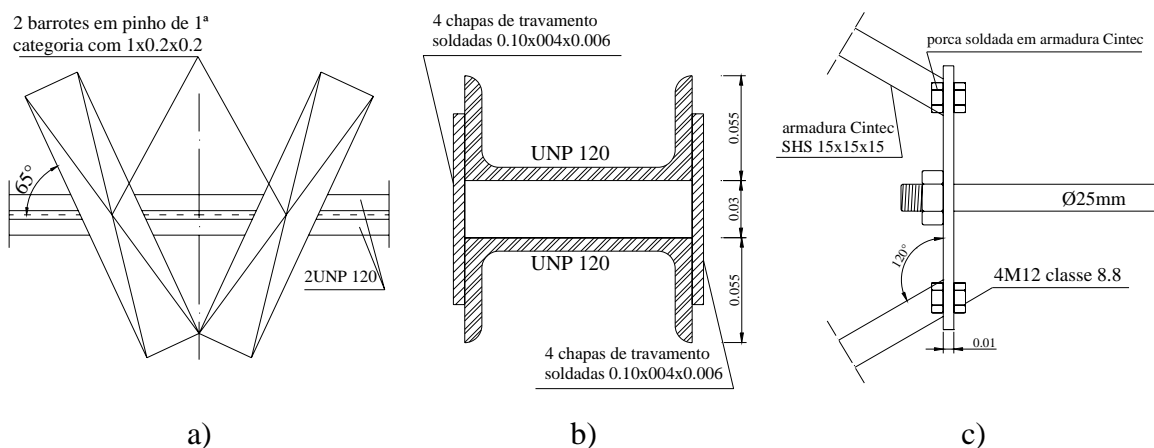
[4h]: Elementos acessórios ao empuxe. a) Barrotes de madeira para apoio dos macacos; b) Perfil composto com 2 UNP 120, para distribuição de forças aplicadas; c) Sistema para ancoragem do cabo para aplicação da força de tracção pelo macaco
